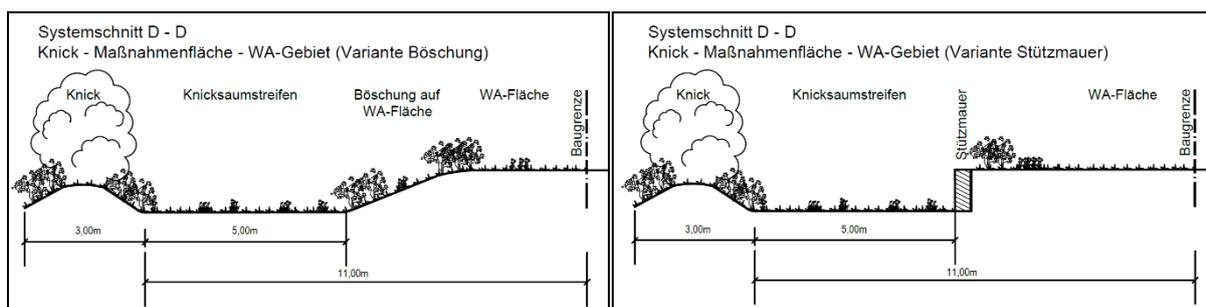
Systemschnitte möglicher Geländeanpassung in zwei Varianten (s. Planzeichnung).
